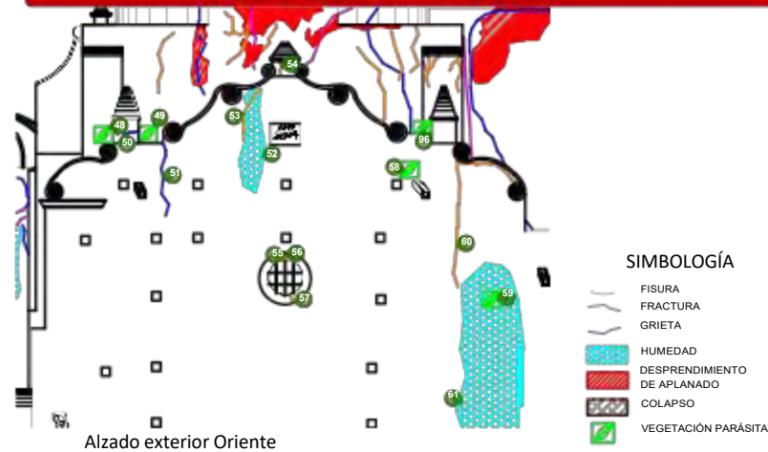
Detalle de fisuras y agrietamientos en muro interior oriente
